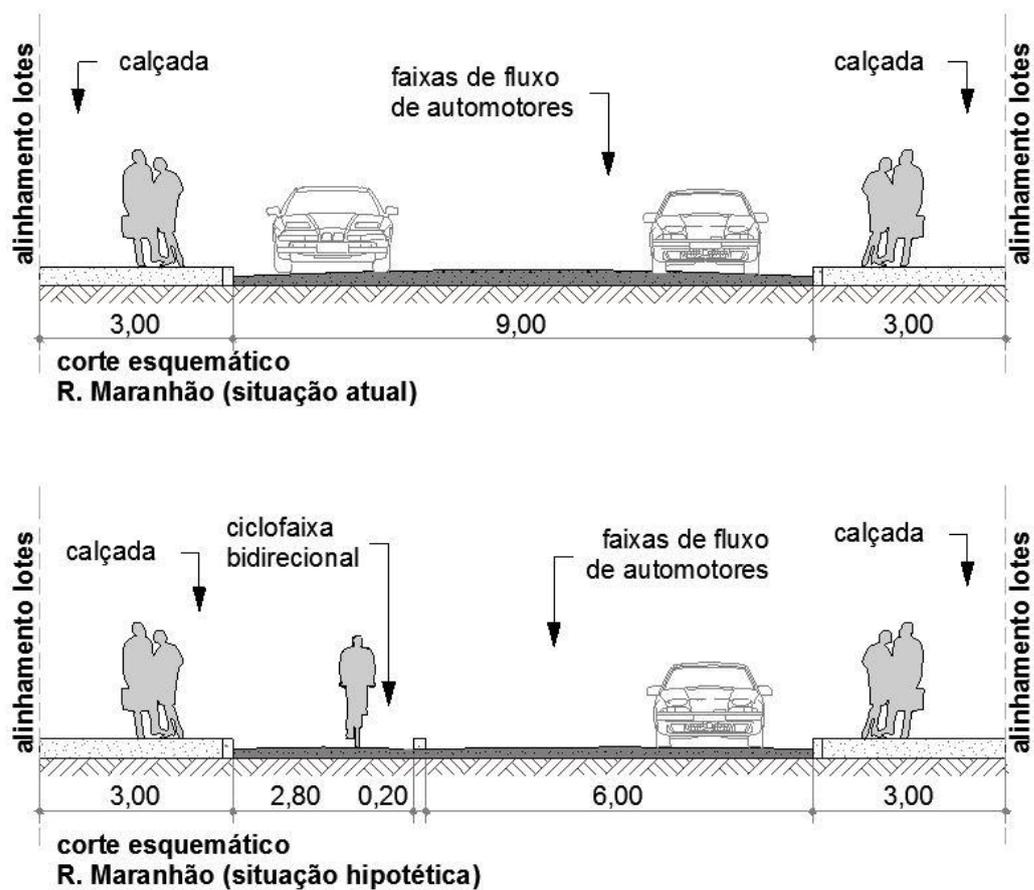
Corte Esquemático R. Maranhão, (fonte: autor)
